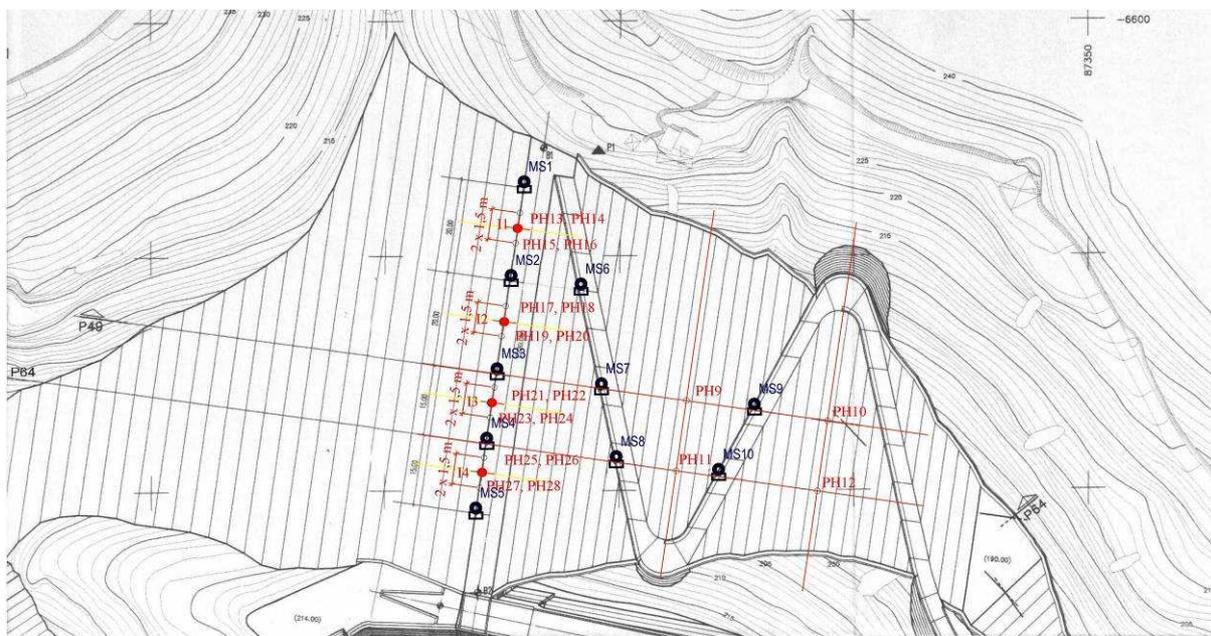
Localização, em planta, dos equipamentos de observação na barragem
